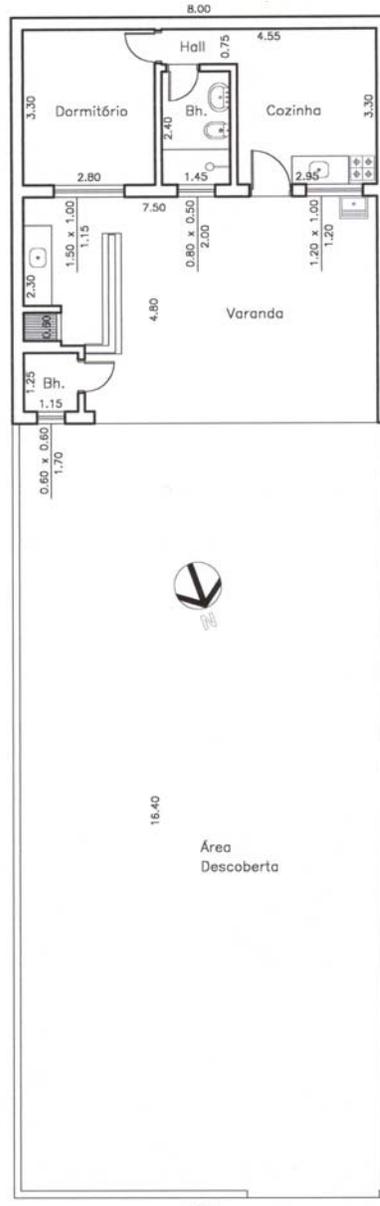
Loteamento Jardim Santa Adélia Q N lote 18
